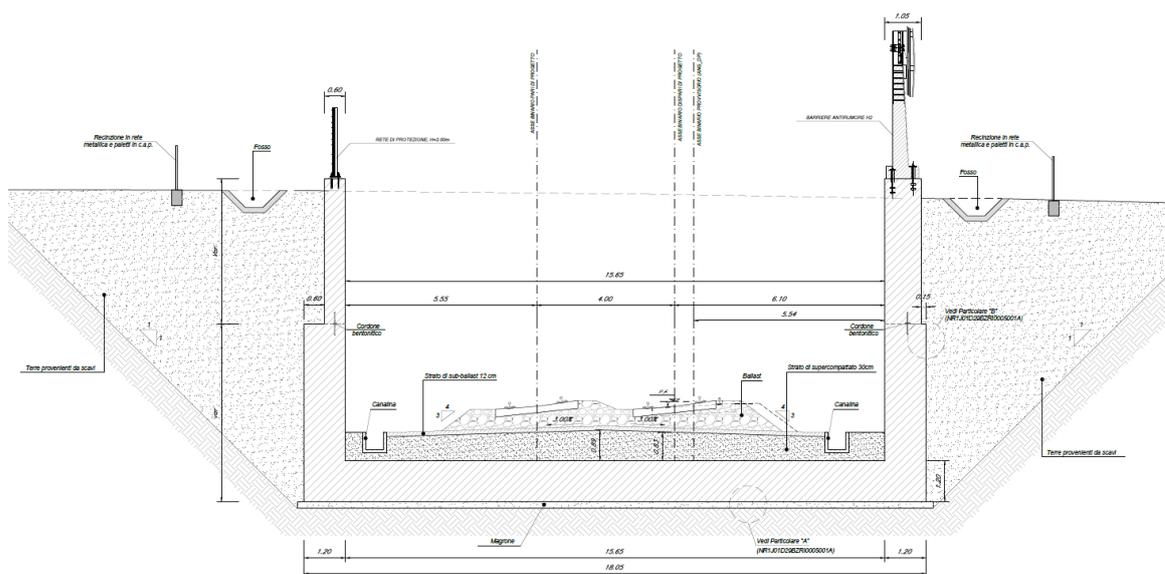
Muro ad U dal km 31+320 al km 31+460- sezione tipo
